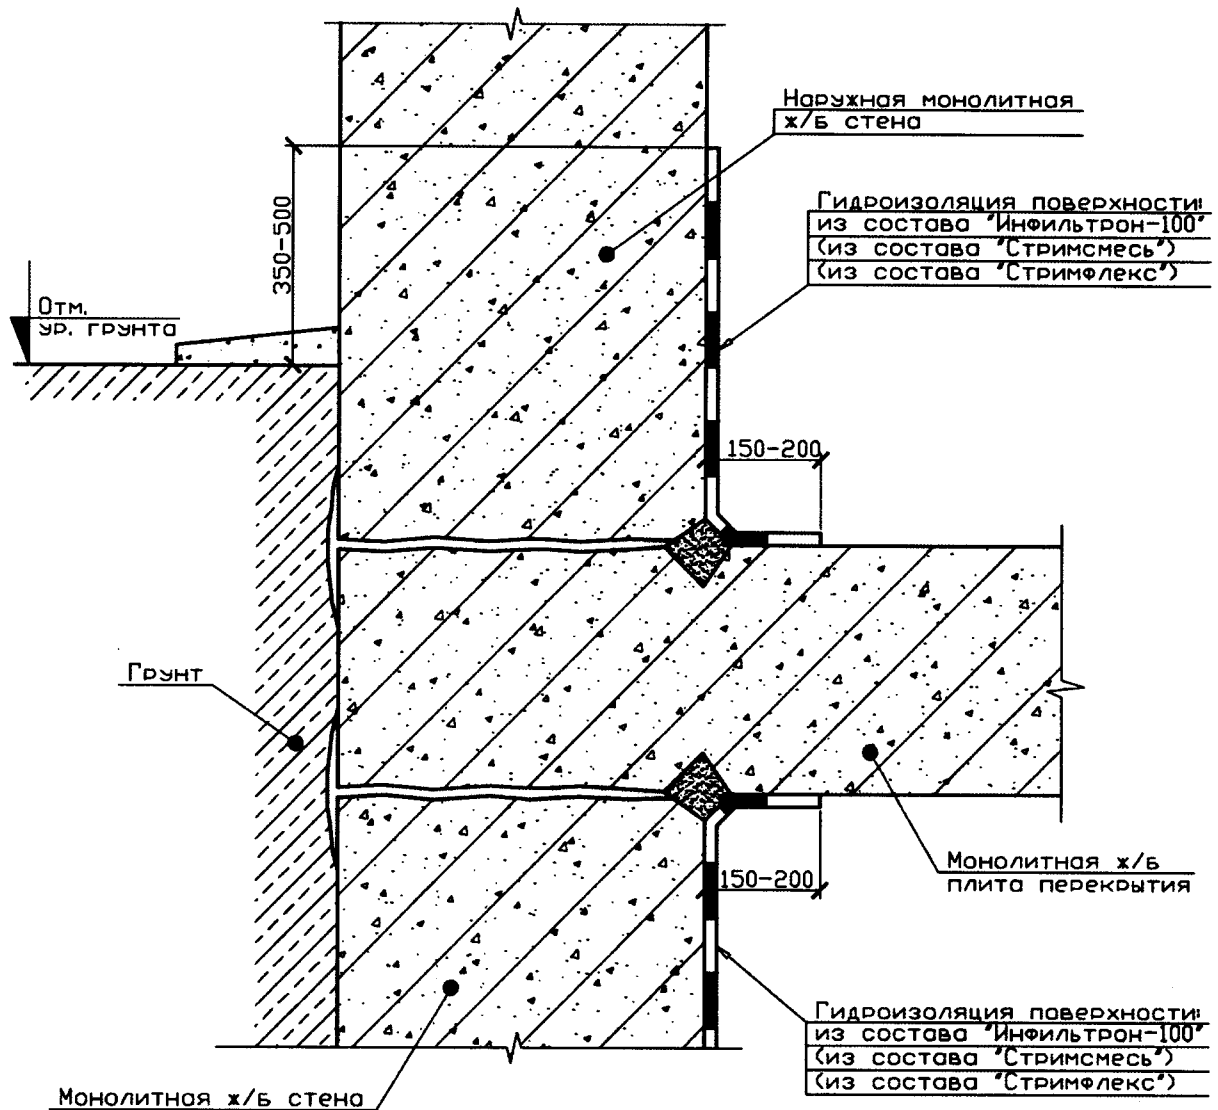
Гидроизоляция поверхностей монолитных железобетонных конструкций. Гидроизоляция поверхностей наружных стен в зоне отметки уровня грунта
